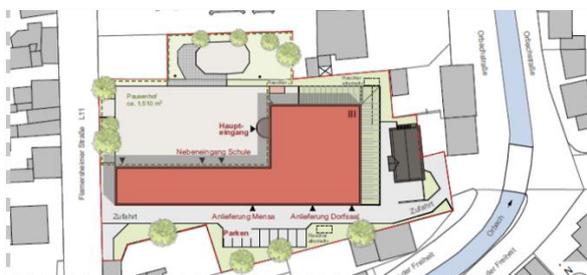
Machbarkeitsstudie Umbau Grundschule mit integriertem Dorfsaal – Lageplan
